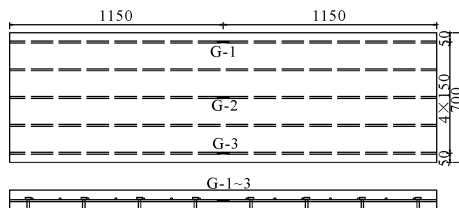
负弯矩试验钢筋应变测点布置图(单位:mm)
